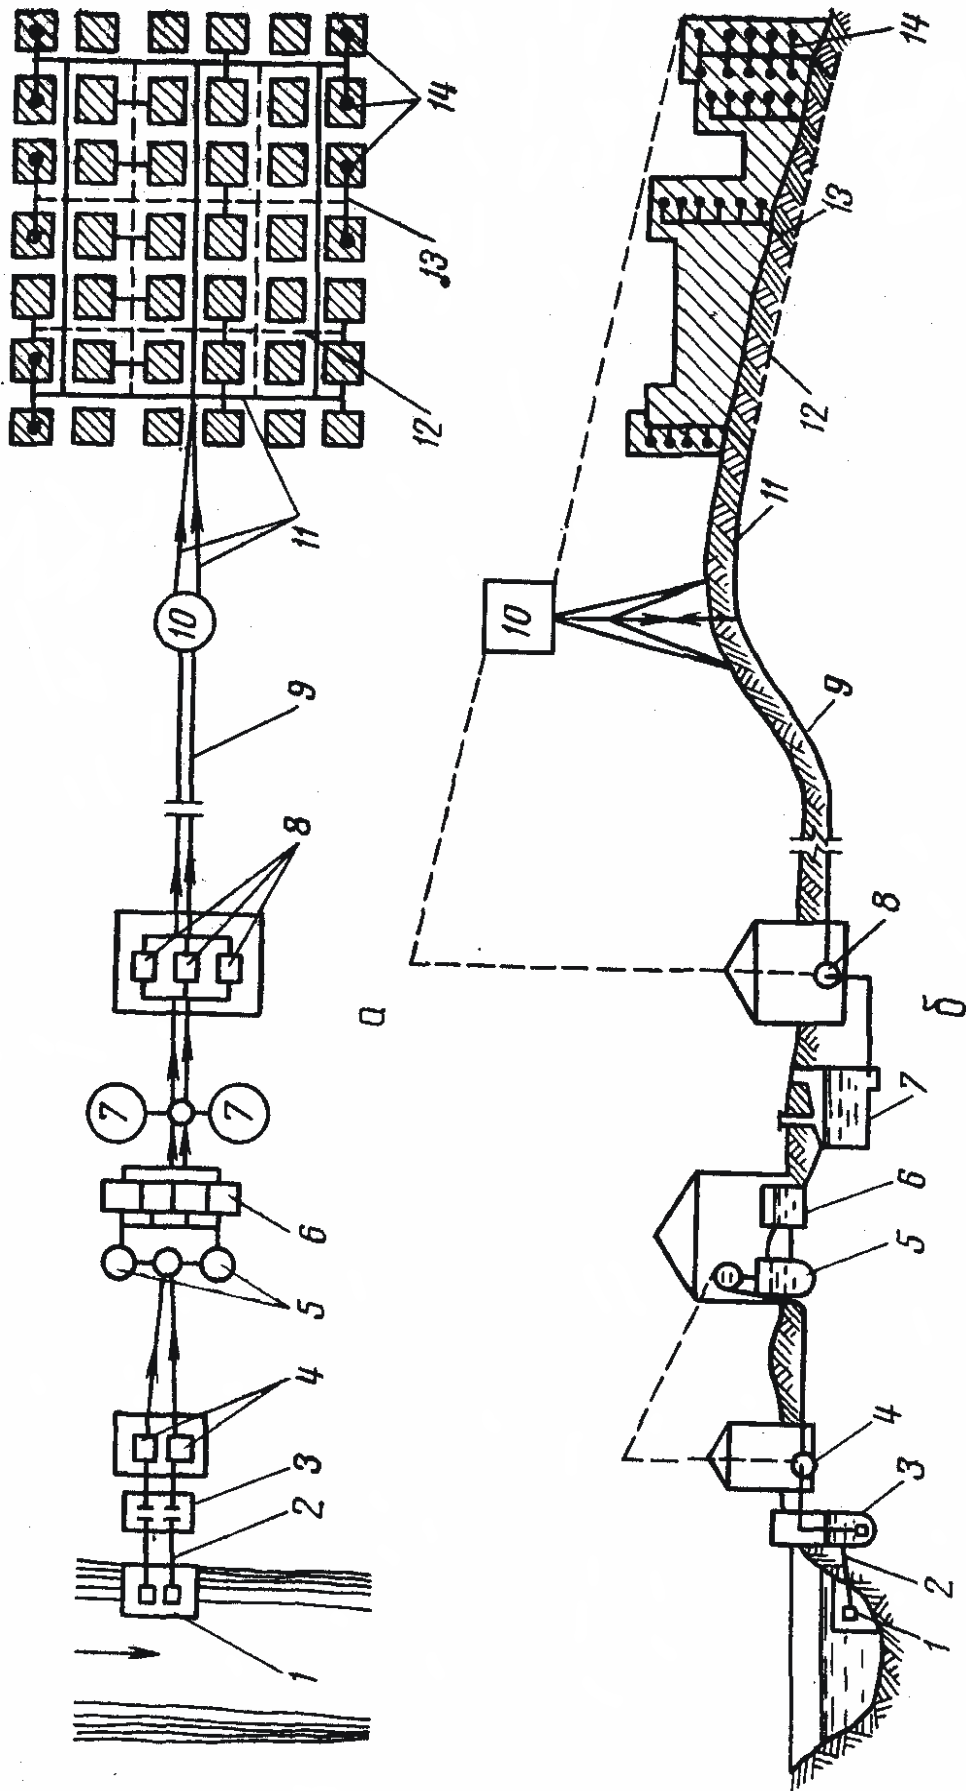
Схема водоснабжения населенного пункта: а — план; б — разрез
